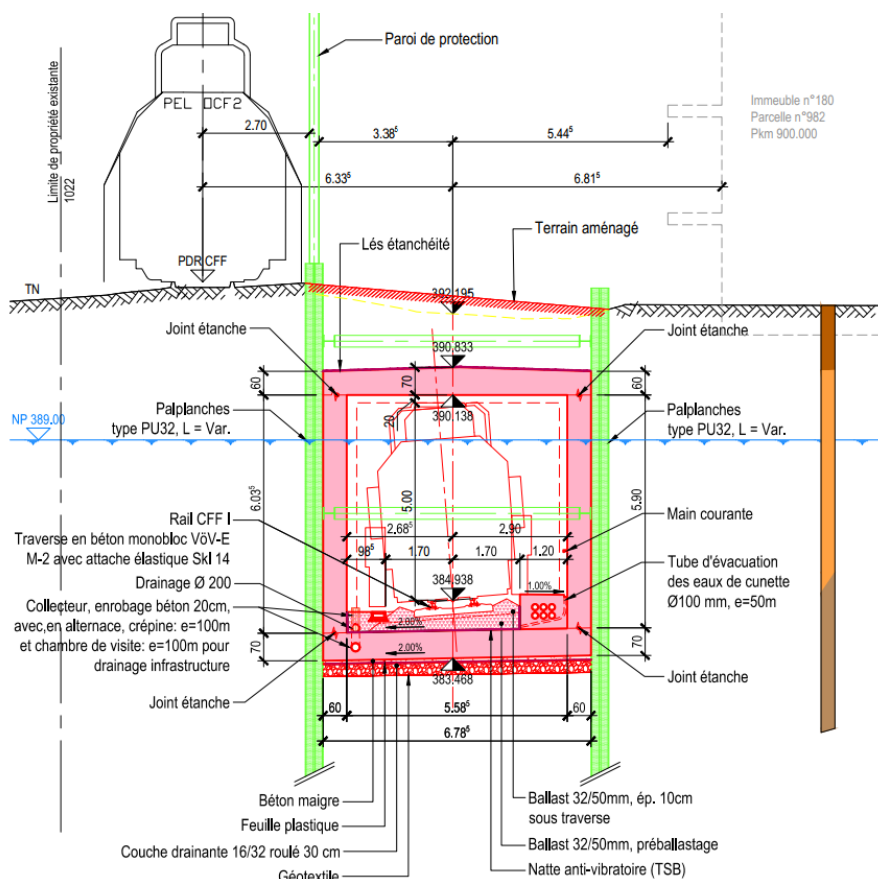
Profil type – tranchée couverte - Secteur St-Didier.
